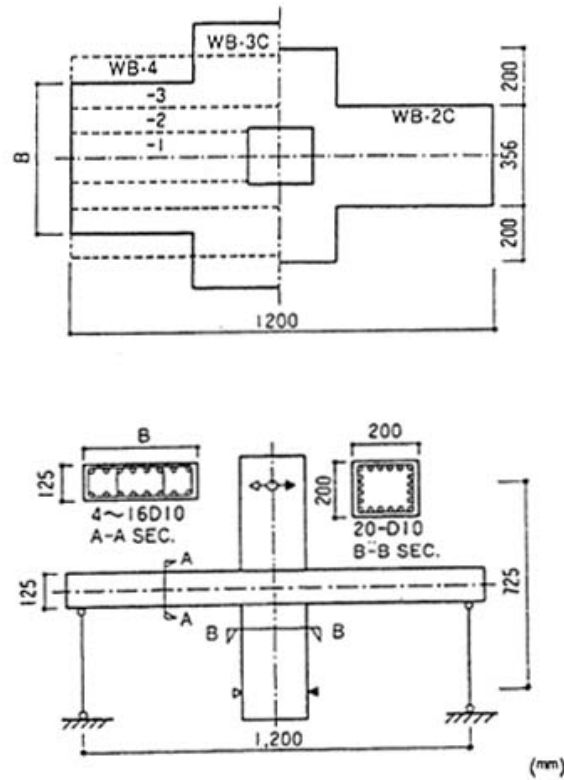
Junta interior viga plana-columna ensayada por Hatamoto et. al. [3]
